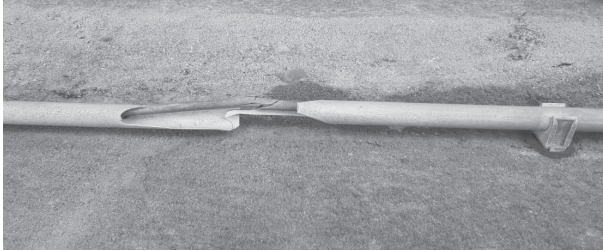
Schäden bei mechanischer Beanspruchung einer UV-Licht-geschädigten Leitung und Installationsrohrs
